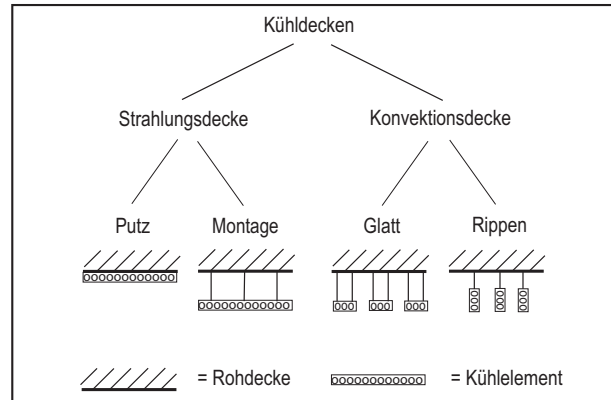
Kühldecken-Hauptgruppen und Bauformen
